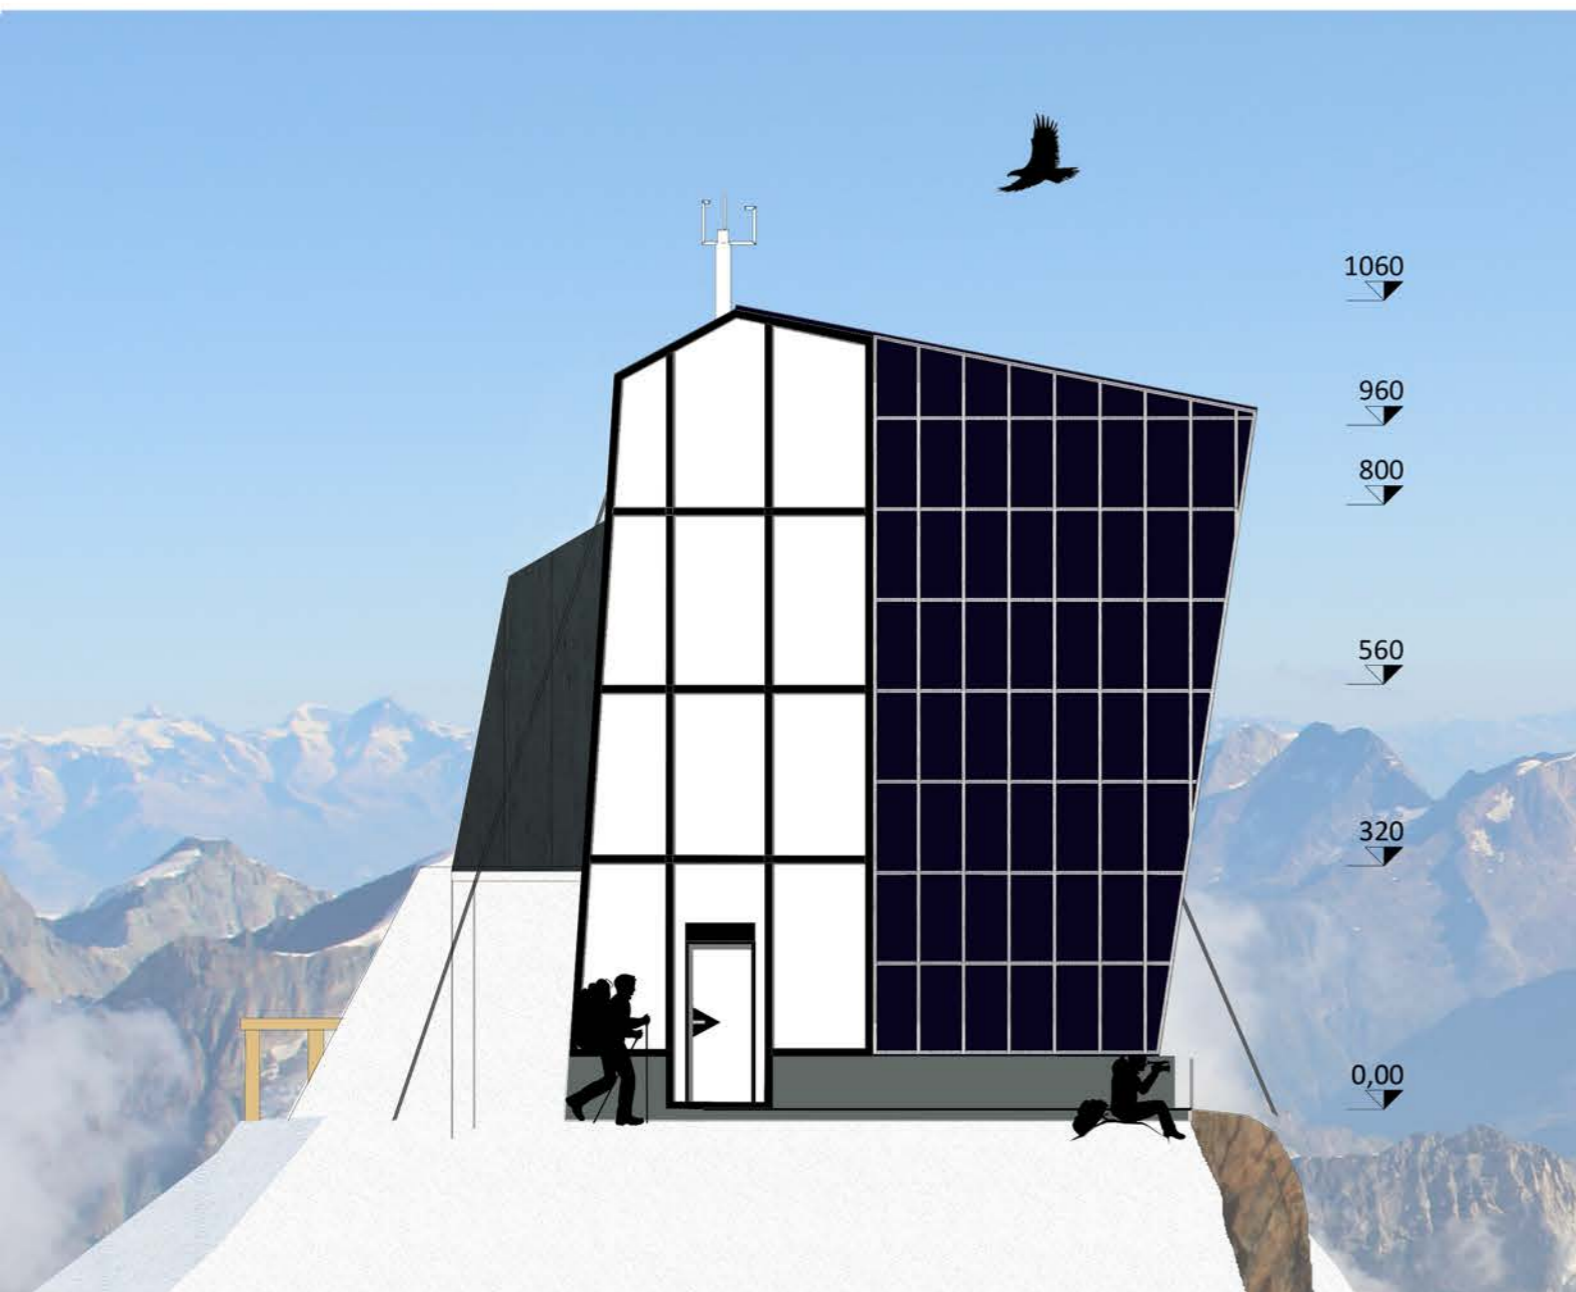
Prospetto sud-ovest scala 1:100.
